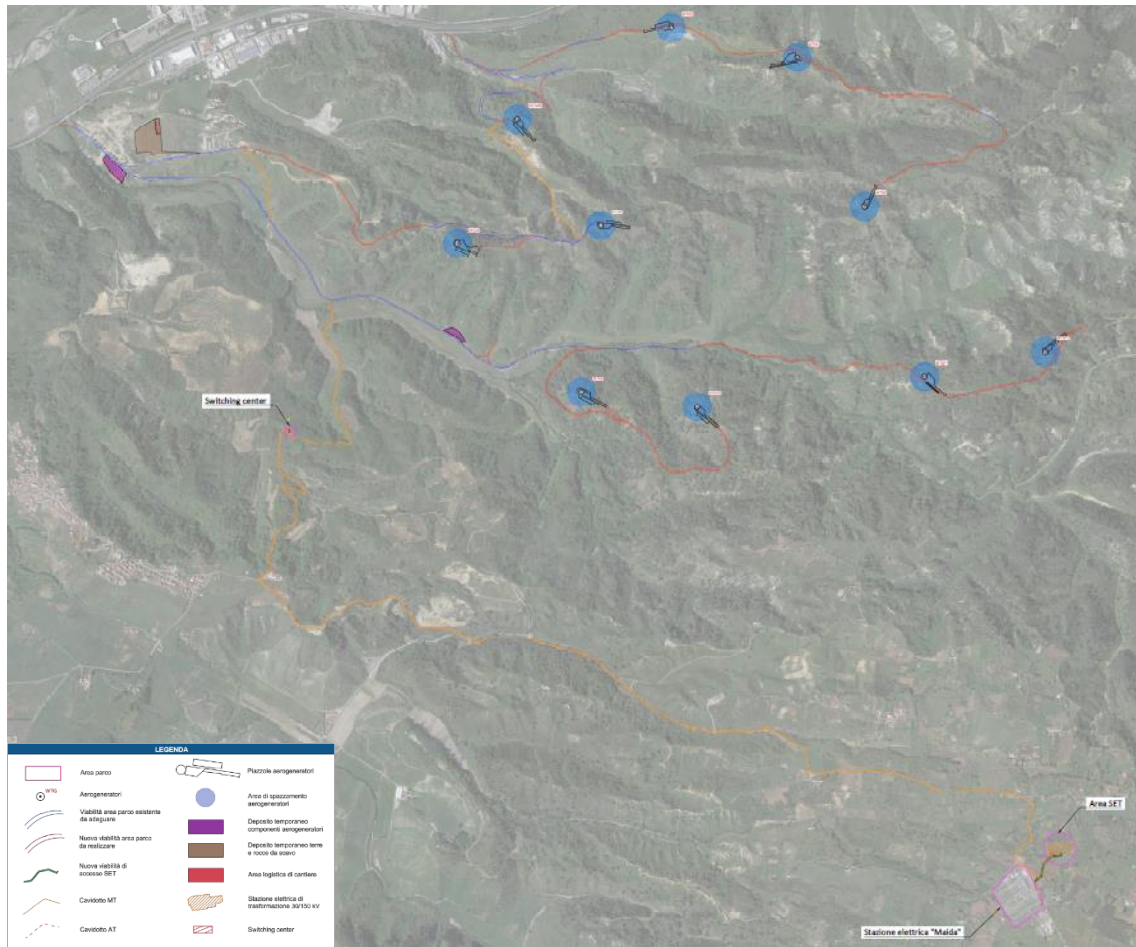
Planimetria di ubicazione dell'area parco su ortofoto
